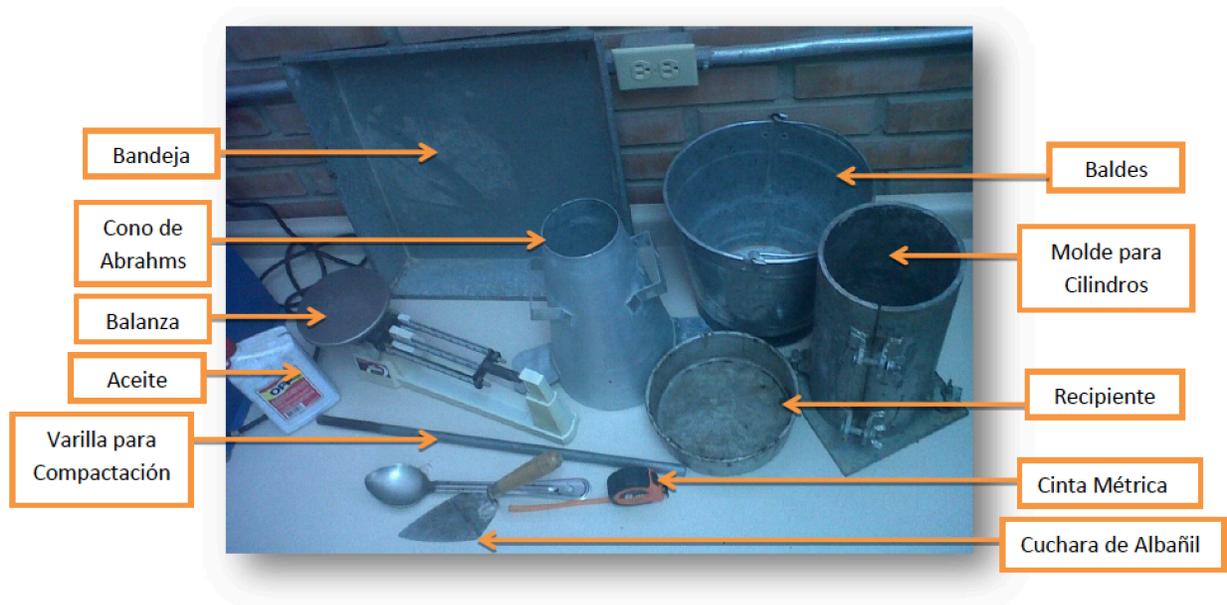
Instrumentos para diseño de mezclas de Hormigón.
